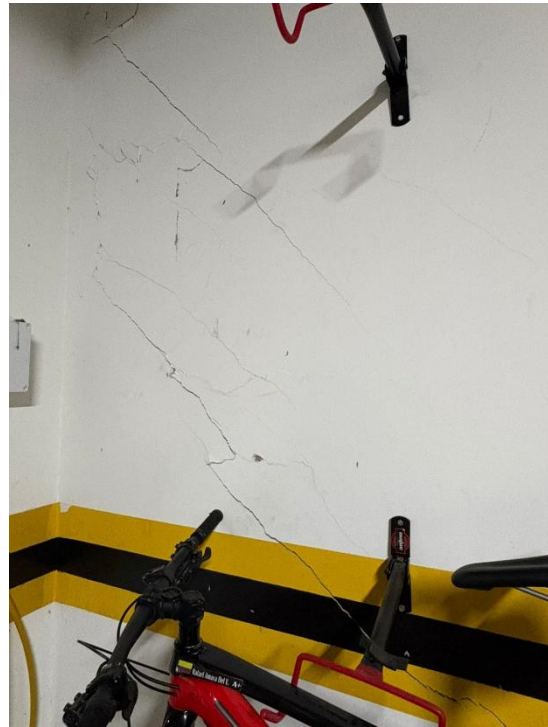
Grietas de asiento en el muro colindante con la vivienda ubicada al este del edificio
